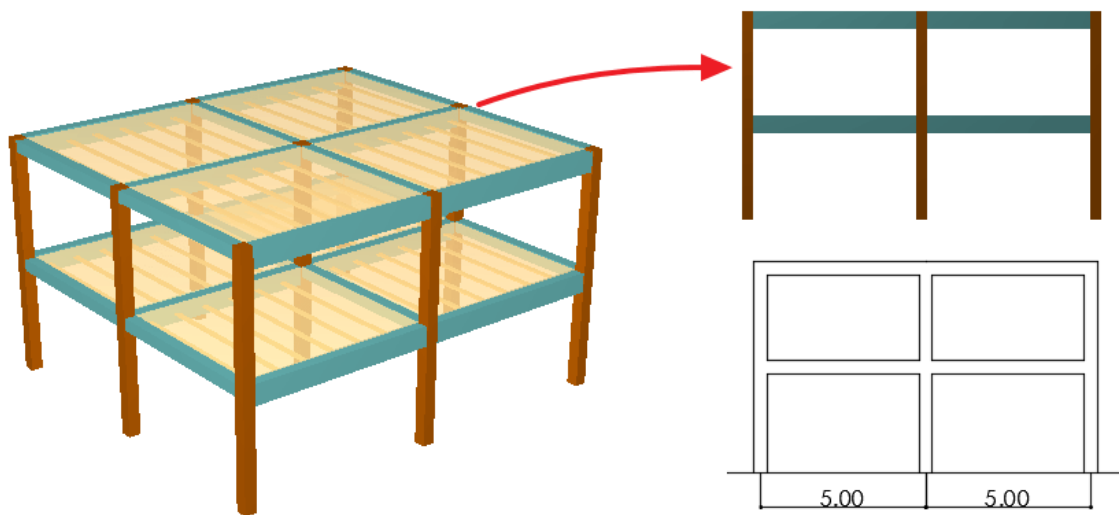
Sistema de pórticos de concreto armado de dos niveles.
